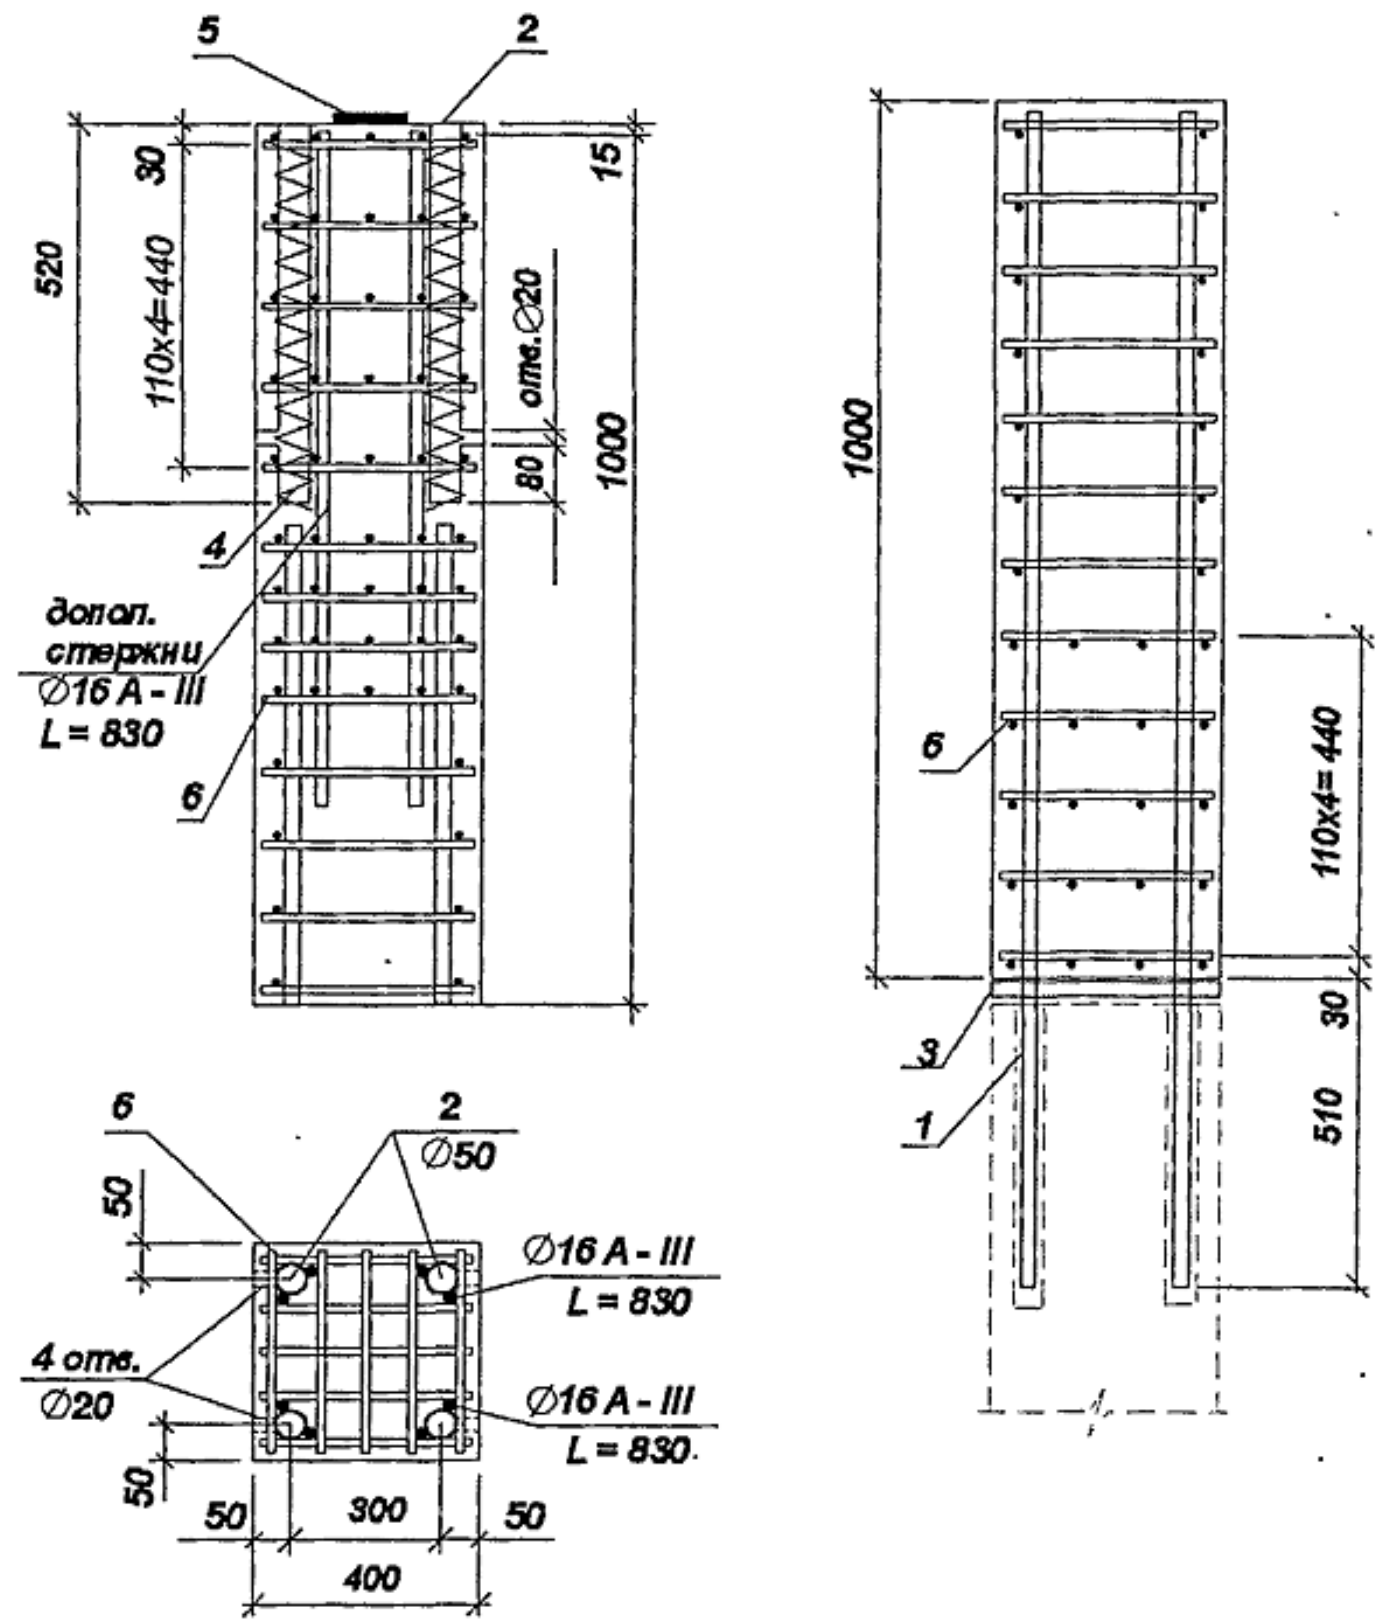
Фрагмент железобетонной колонны со штепсельным стыком
